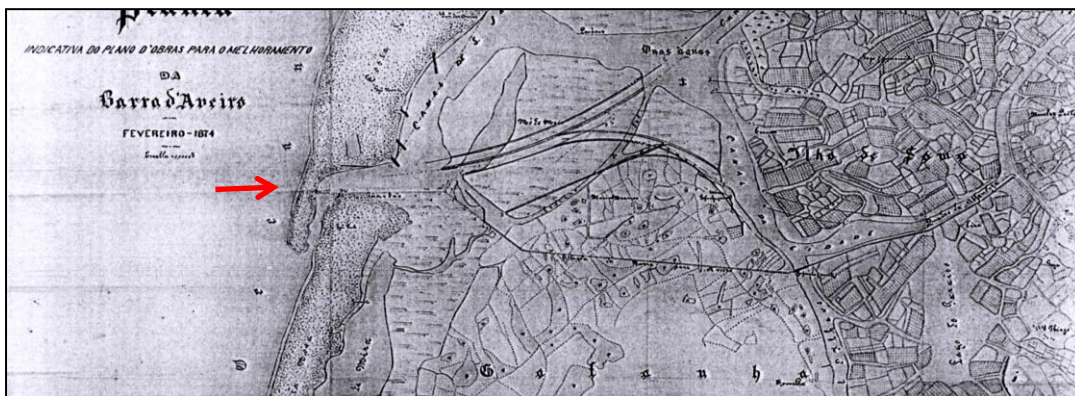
Planta que mostra a restinga de Norte para Sul, em 1874, desenvolvida a partir do Molhe Norte da entrada da Barra
